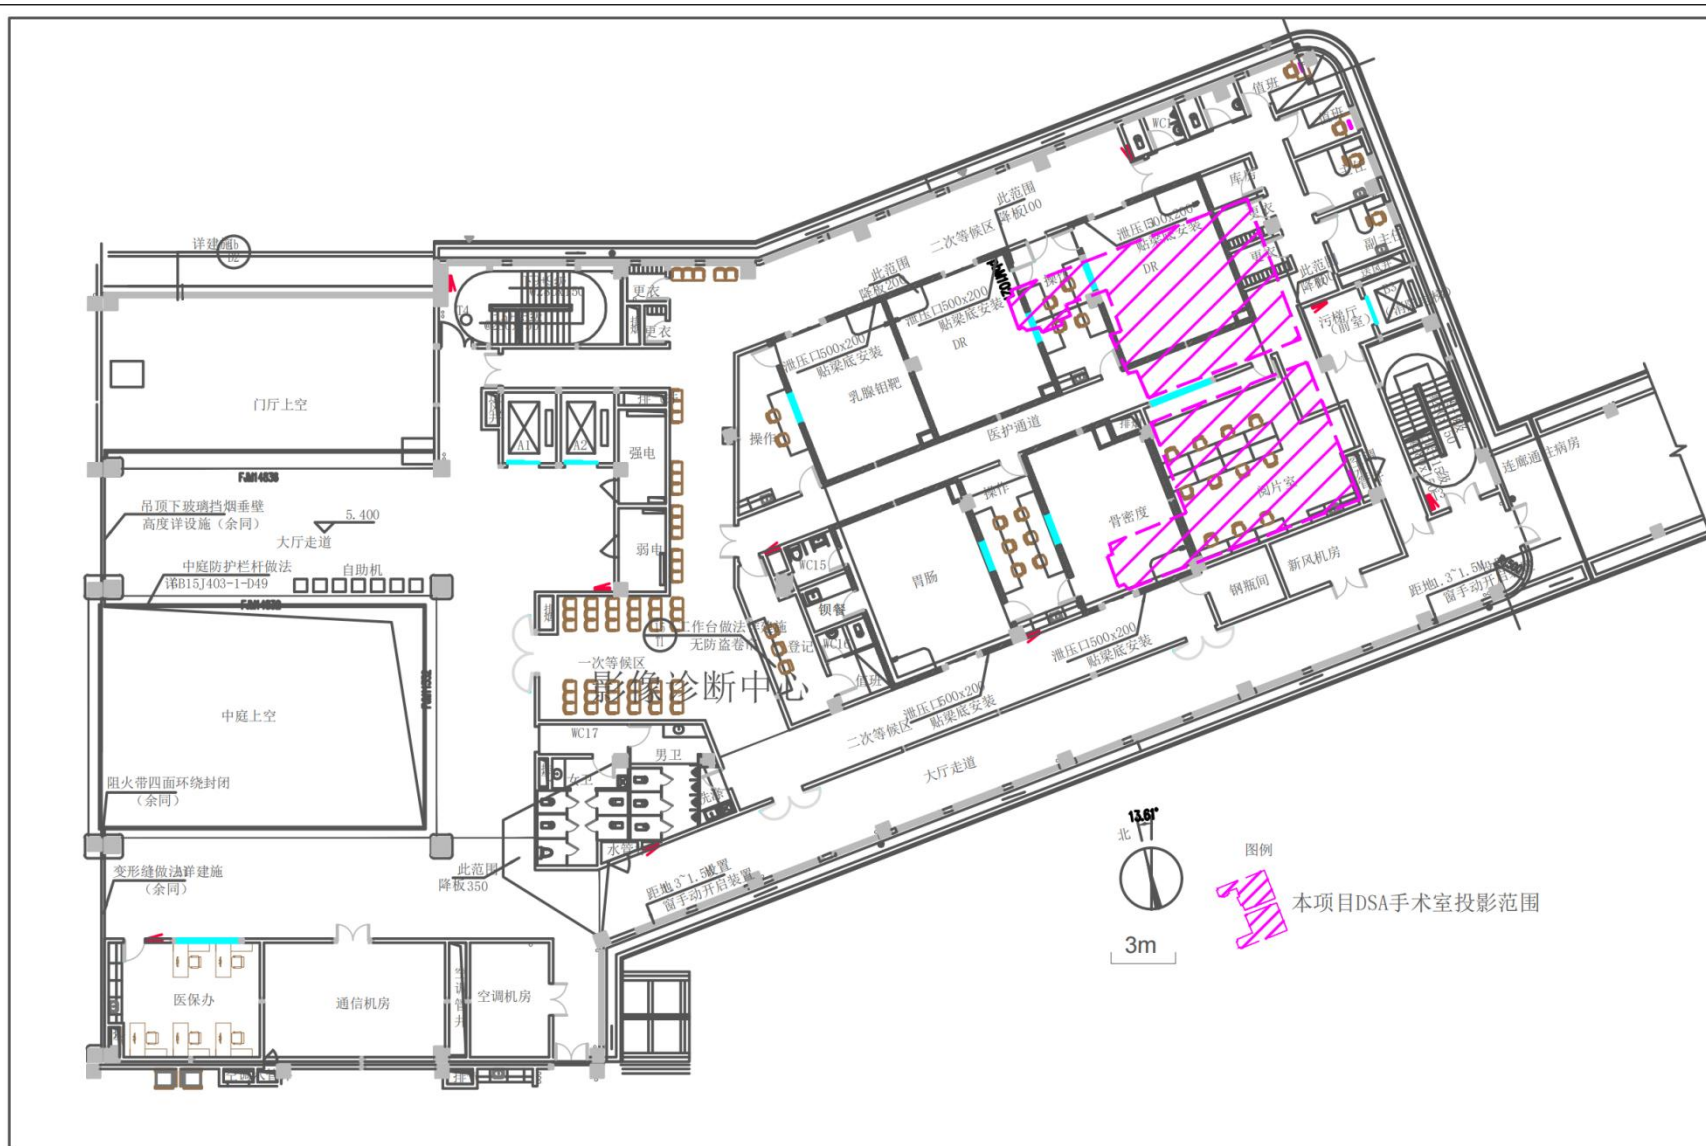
邵武市立医院门诊医技教学综合楼二层局部平面图
